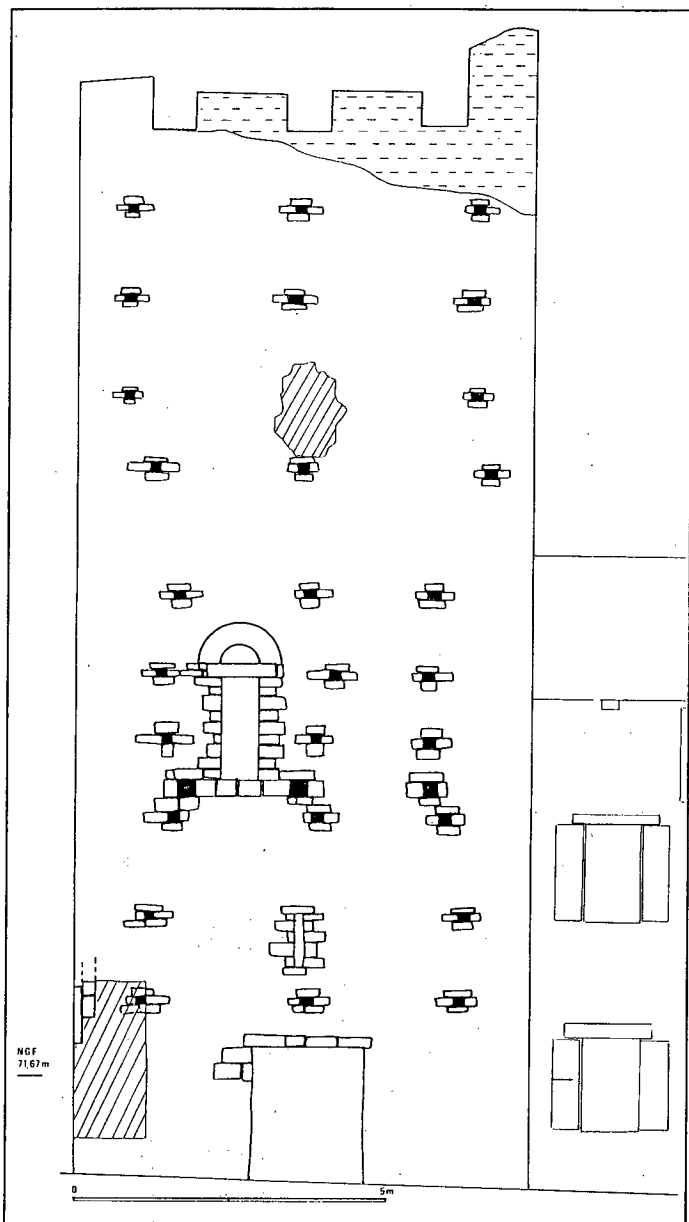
CAMARET, Tour "sarrasine". Relevé d'élévation, mur est, parement externe.
